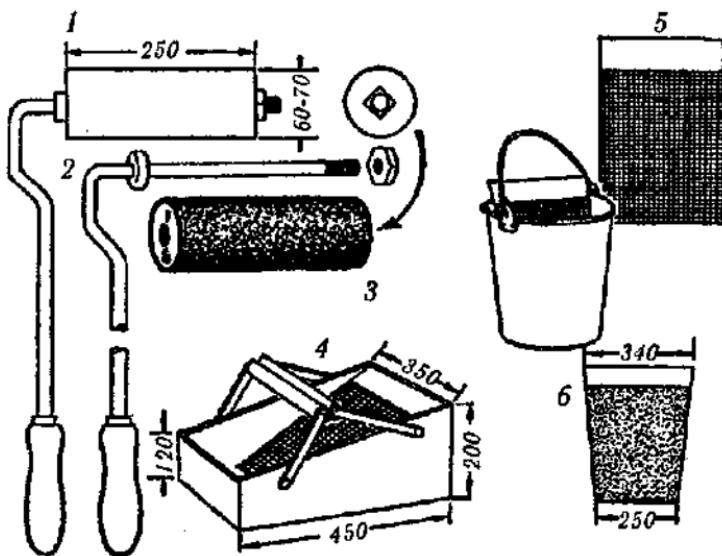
Валик: 1 — общий вид; 2 — ось с шайбой и гайкой; 3 — металлическая воздувка; 4 — ванночка с сеткой; 5 — лист стали с отверстиями; 6 — ведро с сеткой.
